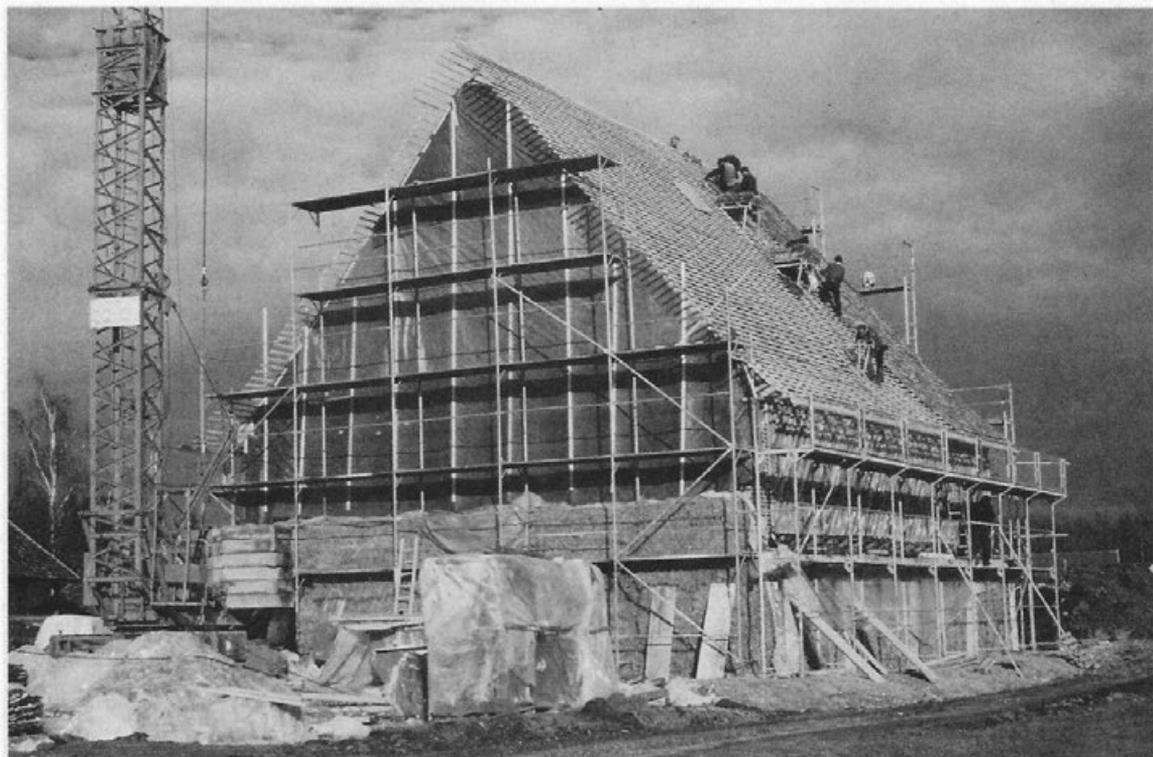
Das Dach ist eingelattet und wird gedeckt. Der Westgiebel ist provisorisch mit Planen zugehängt.
